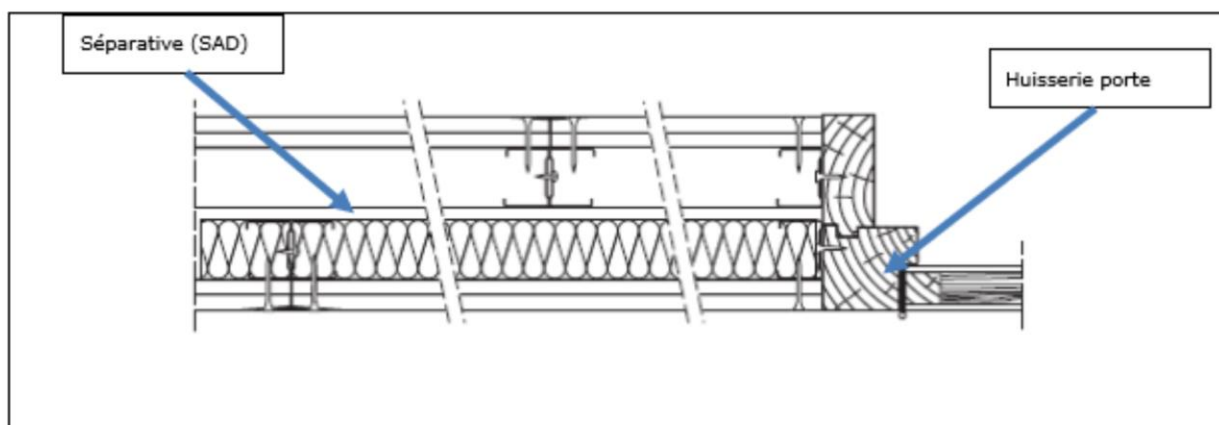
Jonction avec une huisserie bois (coupe horizontale)
